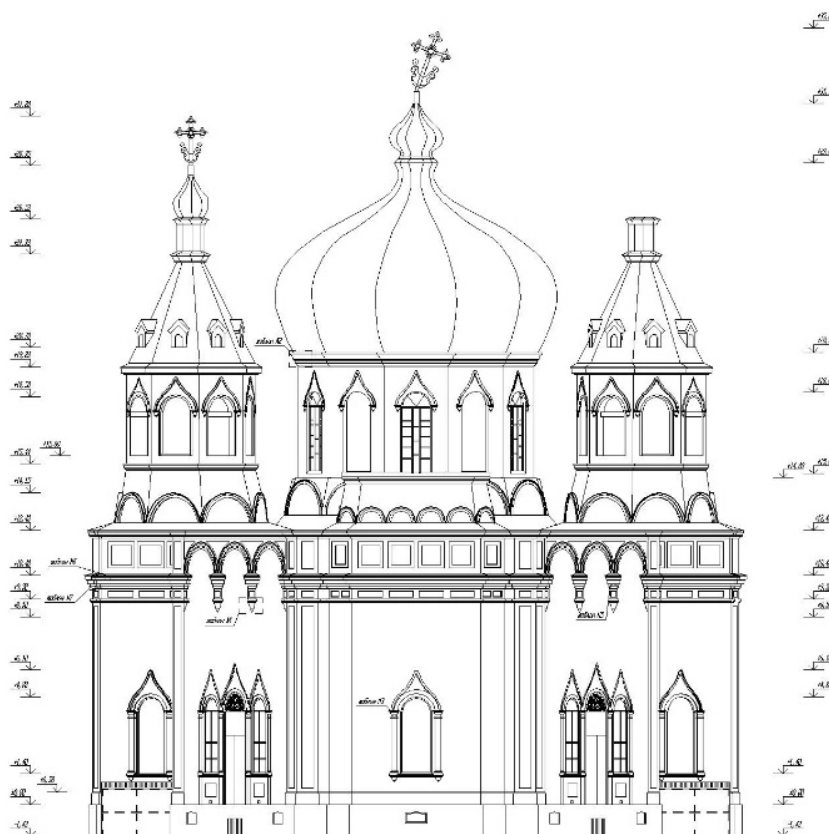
Обмерные чертежи фасадов здания (2022 год):
